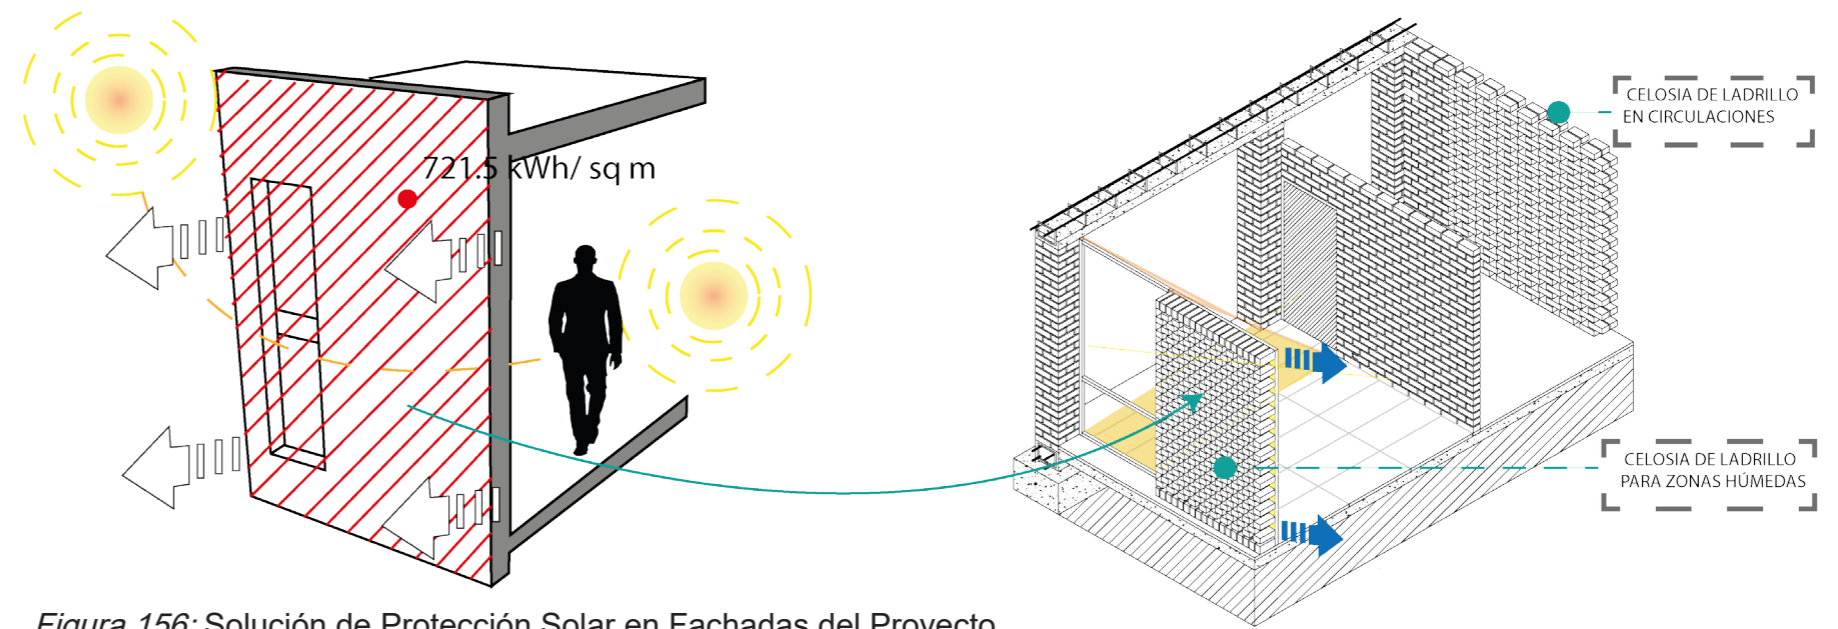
Solución de Protección Solar en Fachadas del Proyecto
